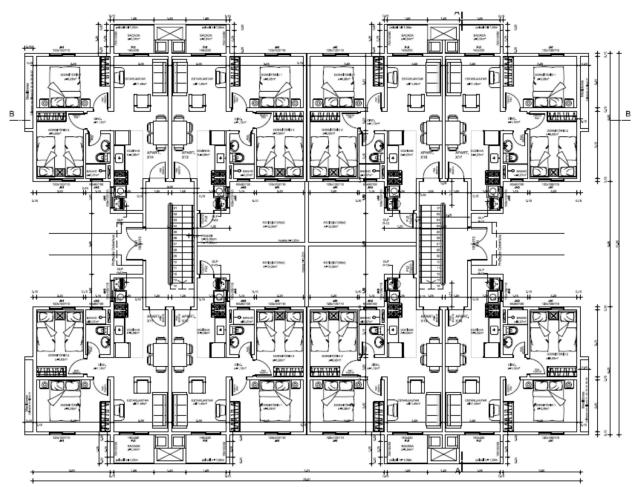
Planta baixa do andar-tipo (oito apartamentos).
